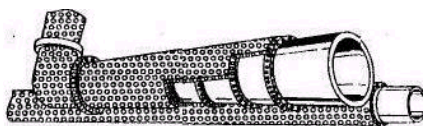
Изоляция труб внутреннего водопровода от конденсации с применением пенофольгированного утеплителя
